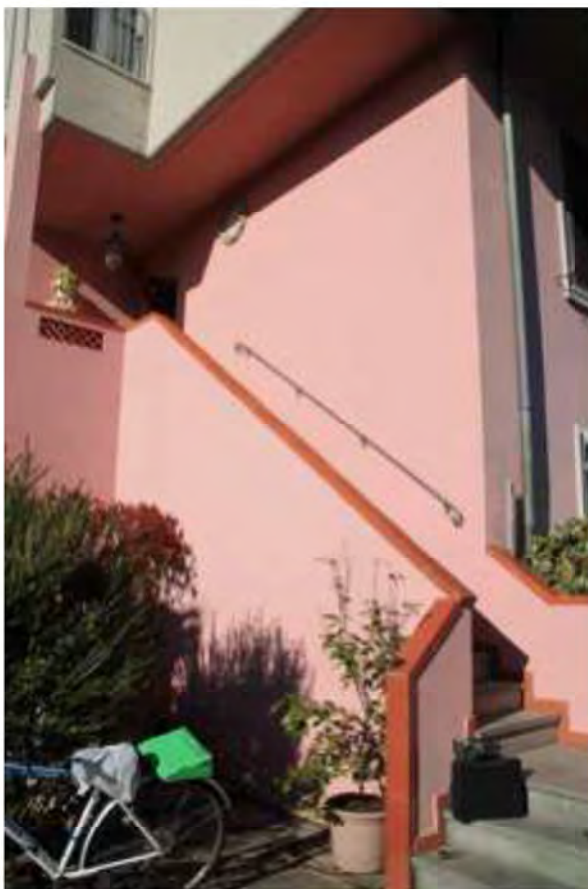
e 36. Scale d'accesso all'appartamento a piano primo
